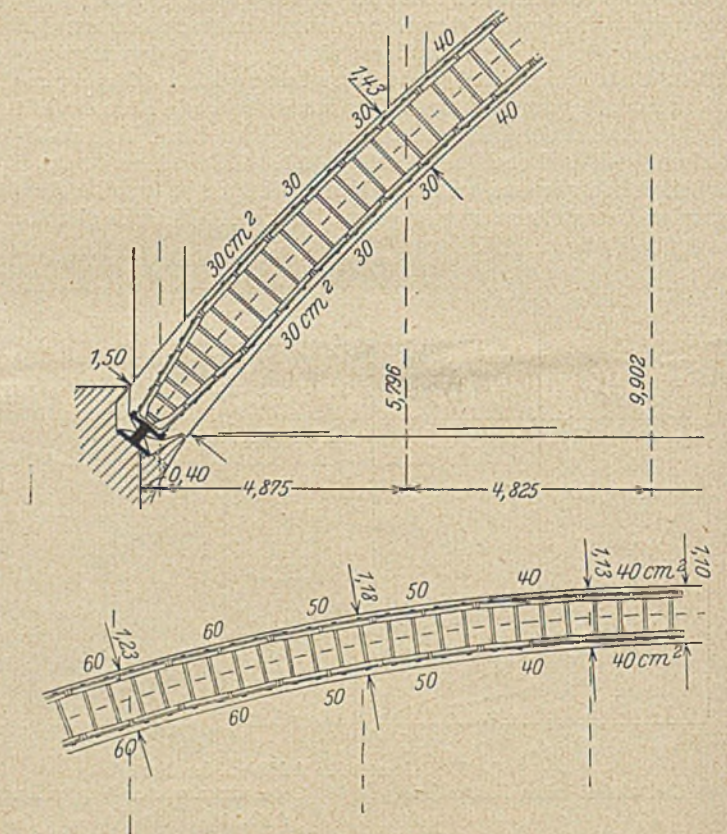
a u. b. Gußeisenarmatur des Bogens.
